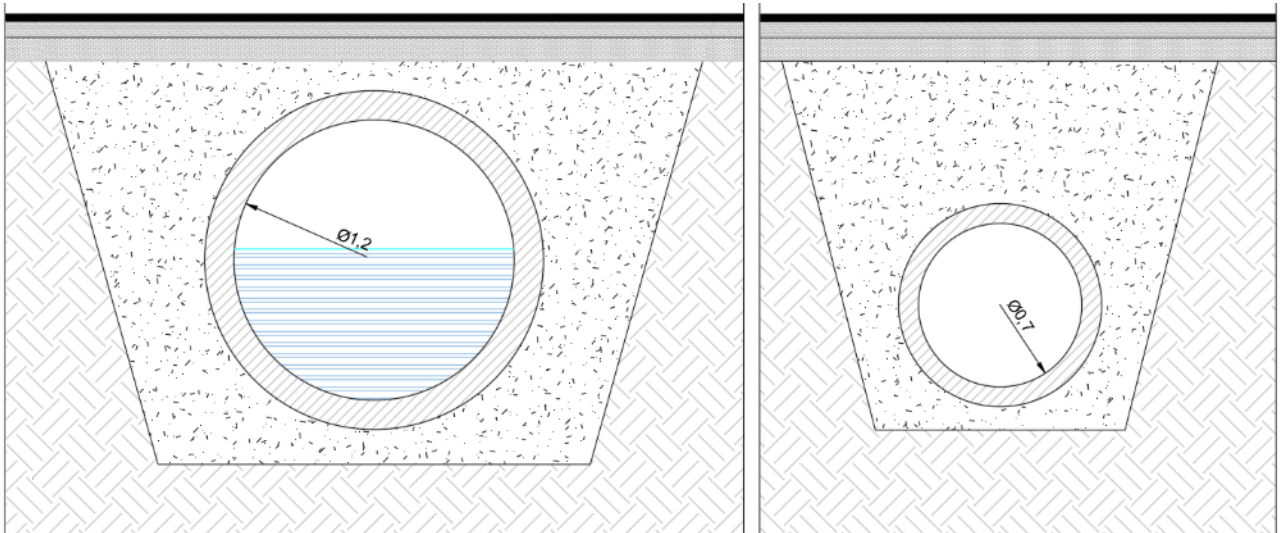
Sezioni tipo delle condotte in calcestruzzo armato vibrocompresso.
